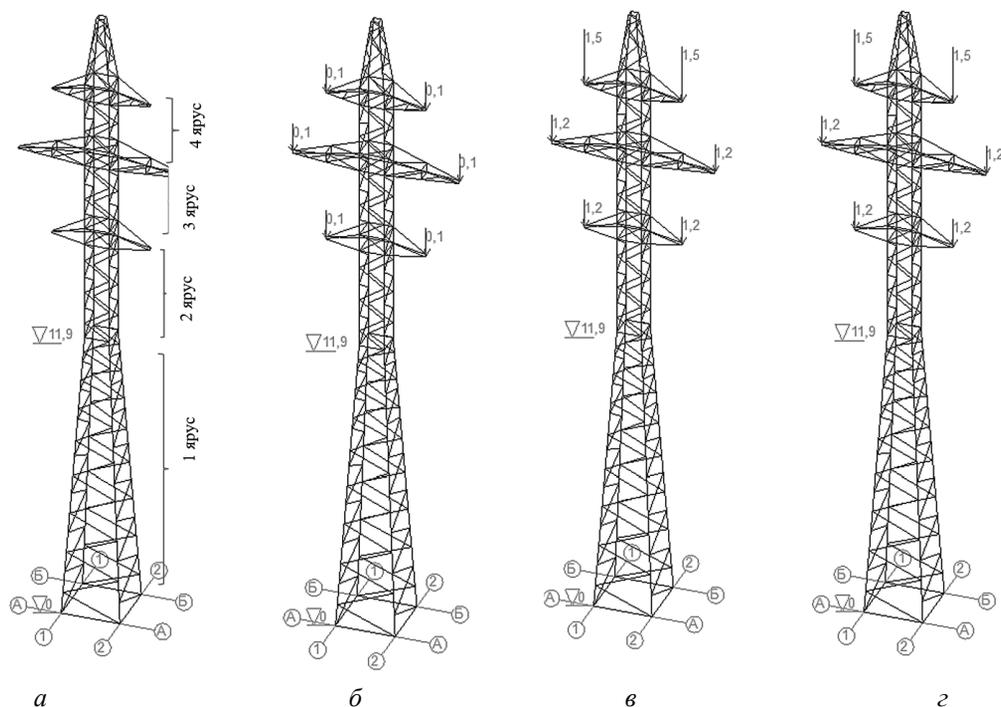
Схемы: а — вертикальный план ВЛЭП; б — расчетная схема; в-г — схемы загрузки опоры ВЛЭП
